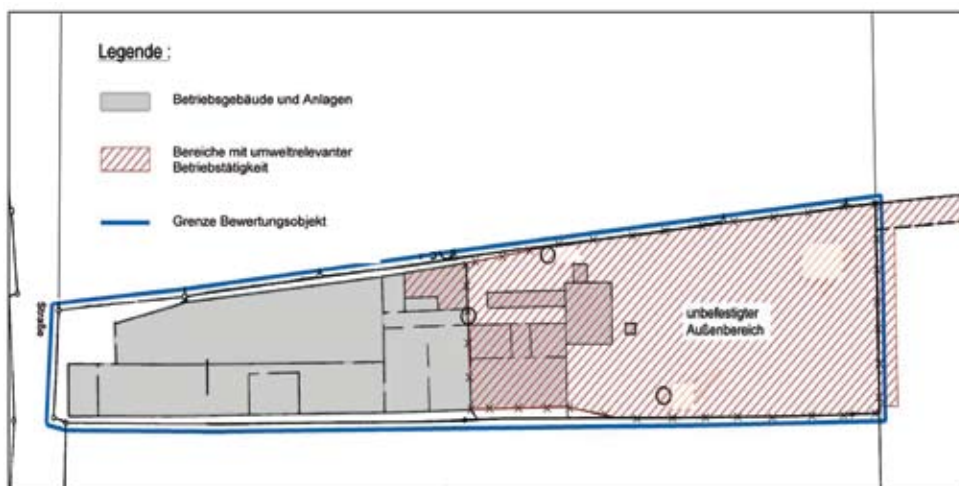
Lageplan des schadstoffbelasteten Bewertungsobjekts
